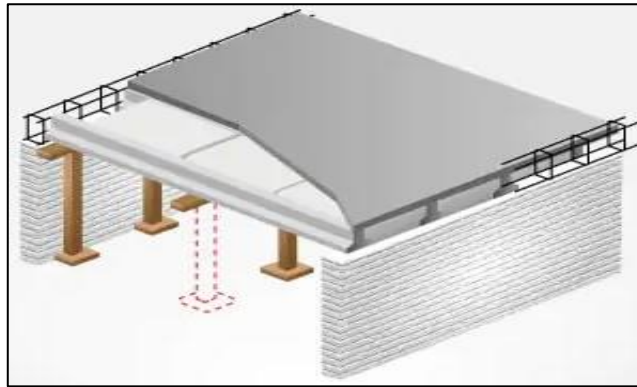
Paso 6: Colocar concreto para formar la losa. Tomada de «Conoce todos los tipos de viguetas que más se utilizan en construcción», por Acero. 2023, p. 1.
